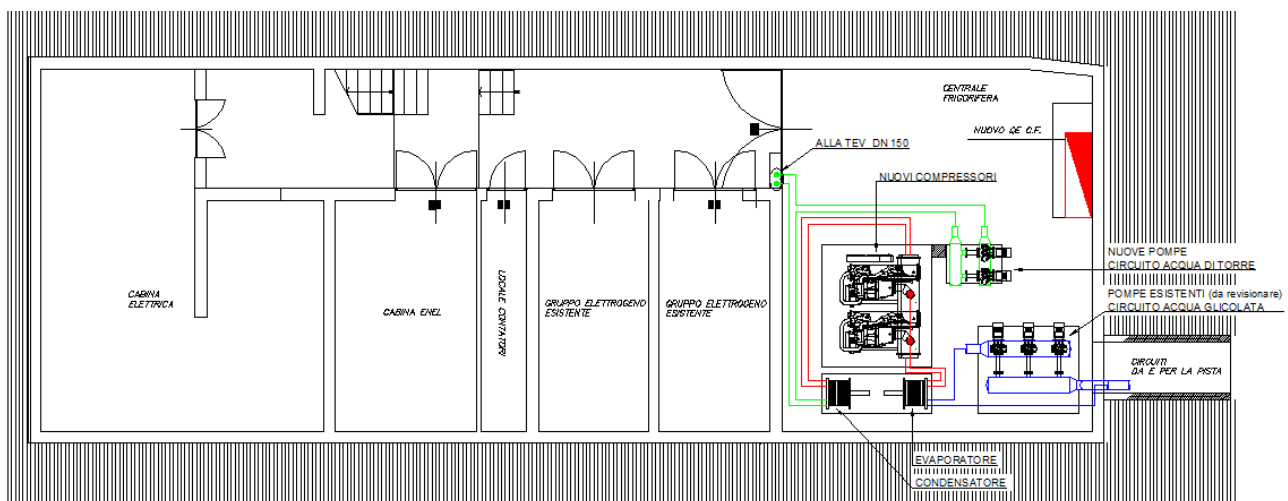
Layout nuovi impianti fluido-meccanici (elaborati tratti dal Progetto Definitivo)
